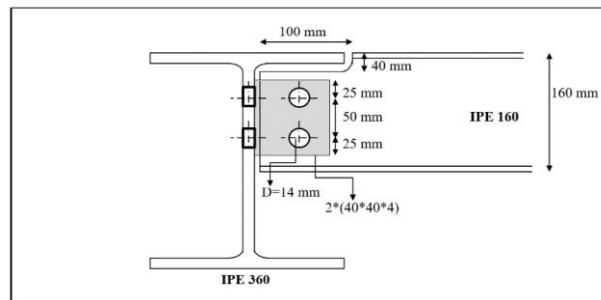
Détail de l’assemblage solive – poutre maitresse.
